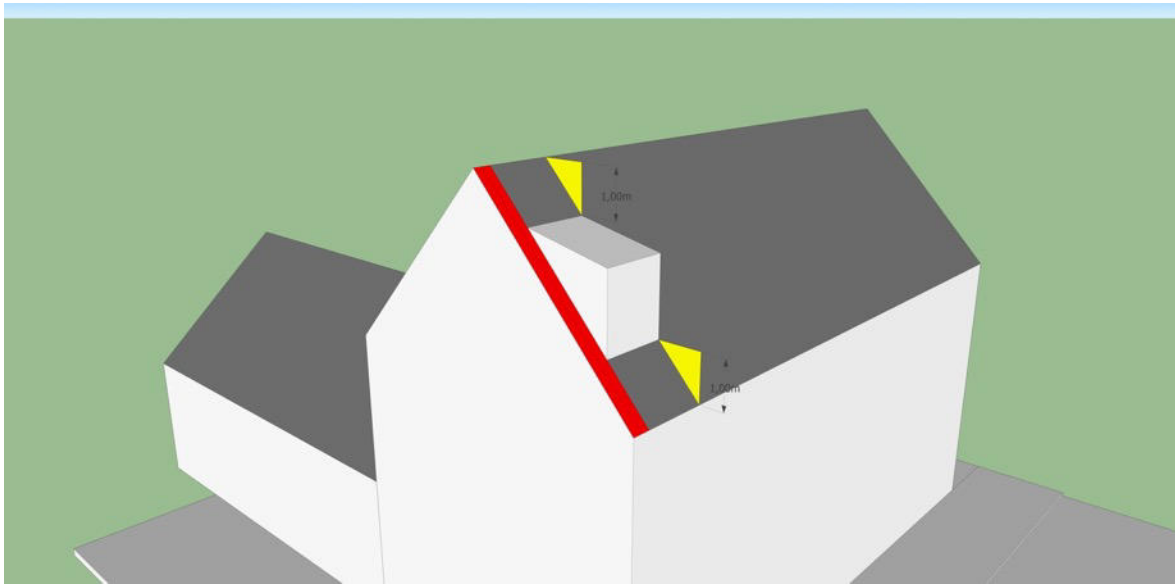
Mindestabstand der Dachaufbauten zum Ortgang, First und zur Traufe gem. Festsetzung Nr. 14.7
